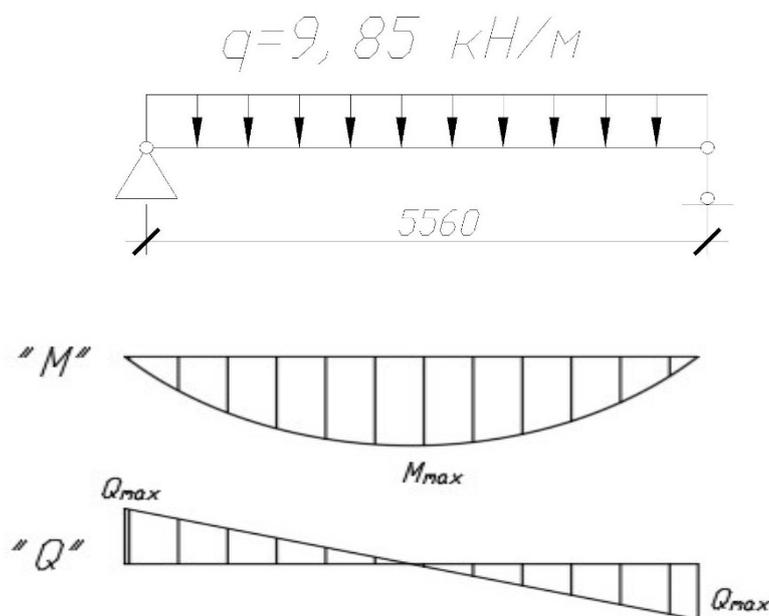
Расчетная схема и эпюры моментов и поперечной силы
